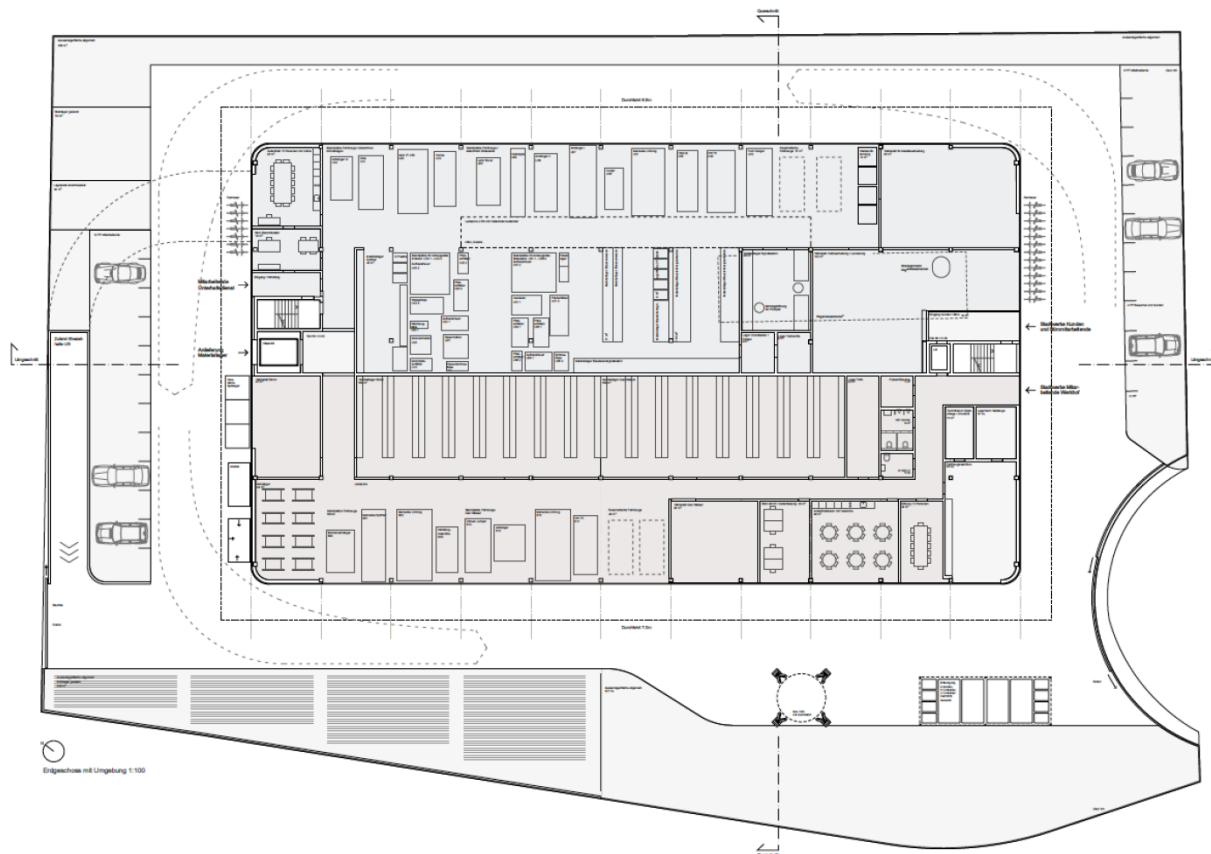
Situation mit Grundriss Erdgeschoss (Quelle: Bietergemeinschaft 3 Steiner AG)
